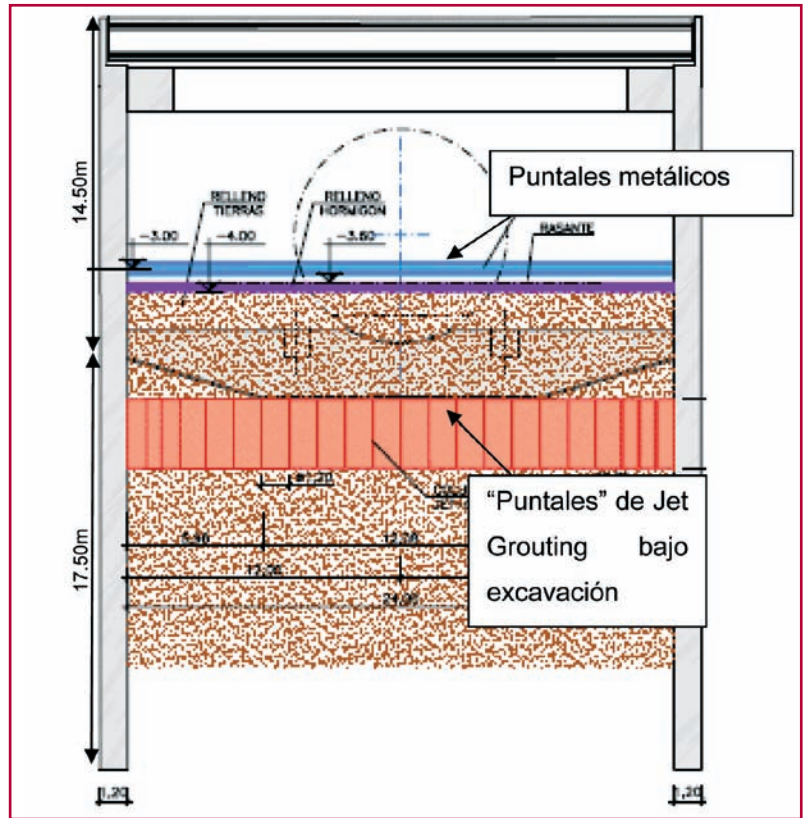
Sección del pozo con puntales metálicos y Jet.
